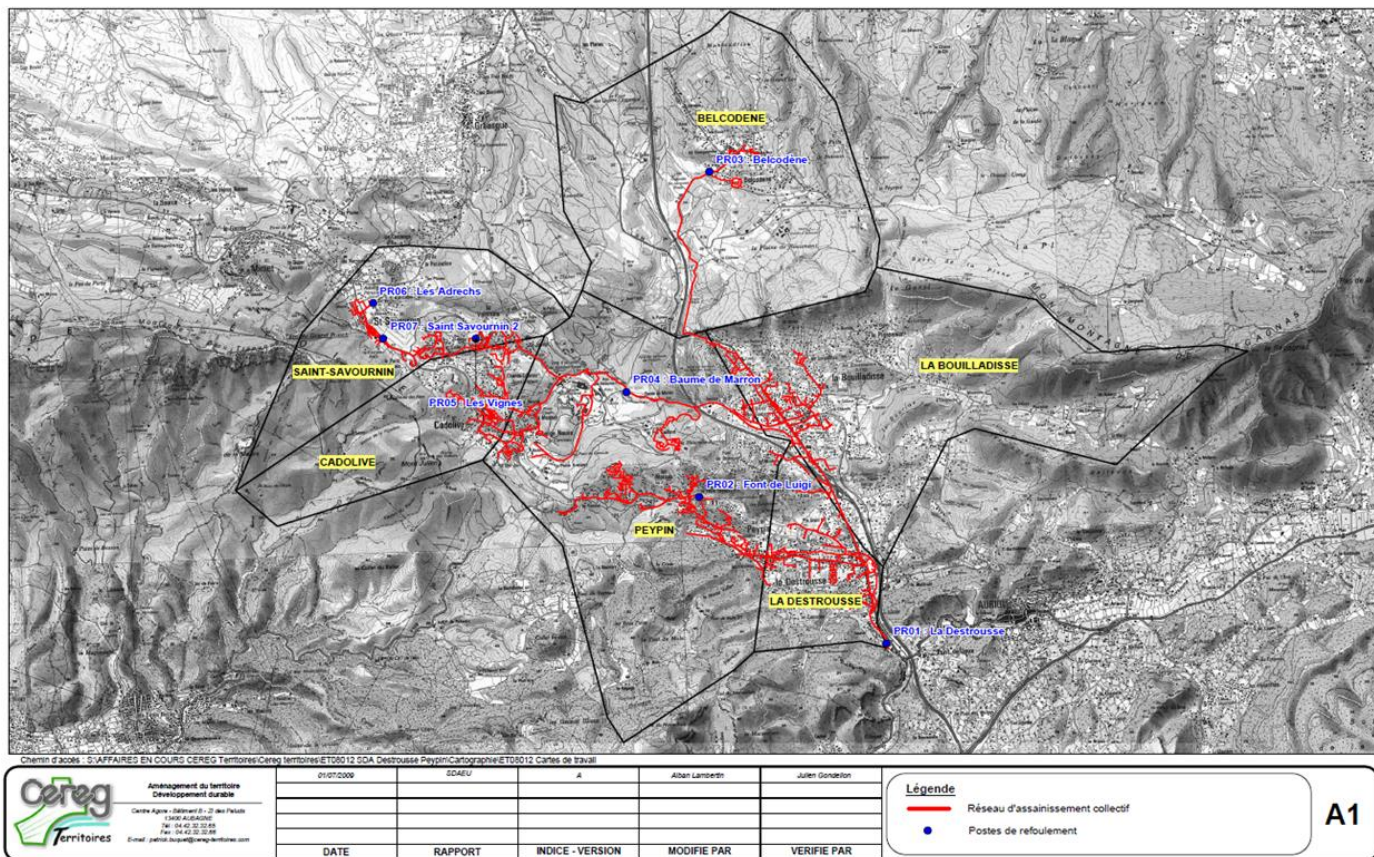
Plan de situation de la collecte - Communes de l'Etoile
